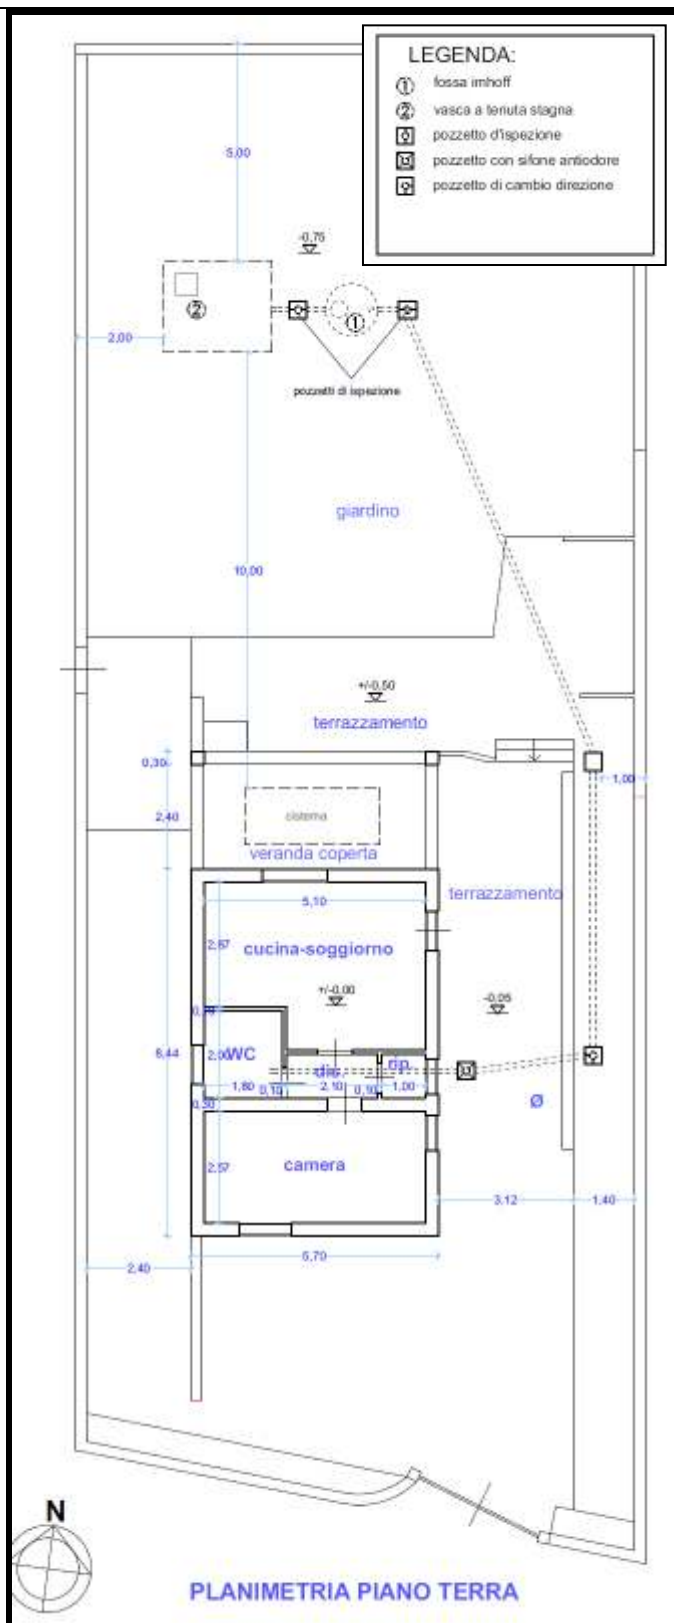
Planimetria generale impianto smaltimento reflui.
